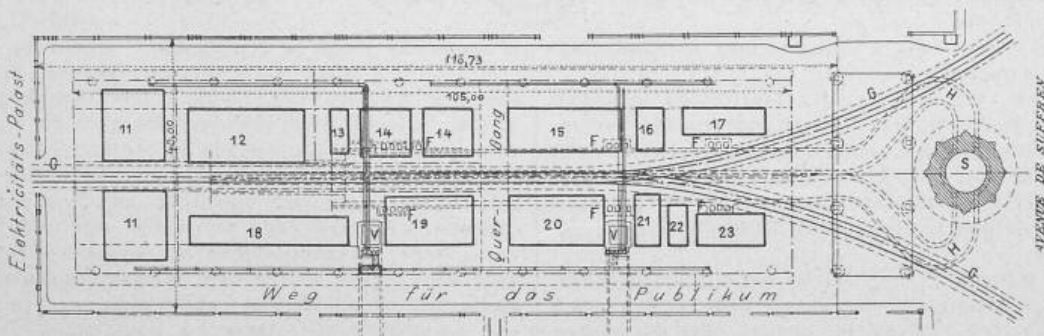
Grundriss des Kesselhauses «Av. de Suffren». 1:1000.
